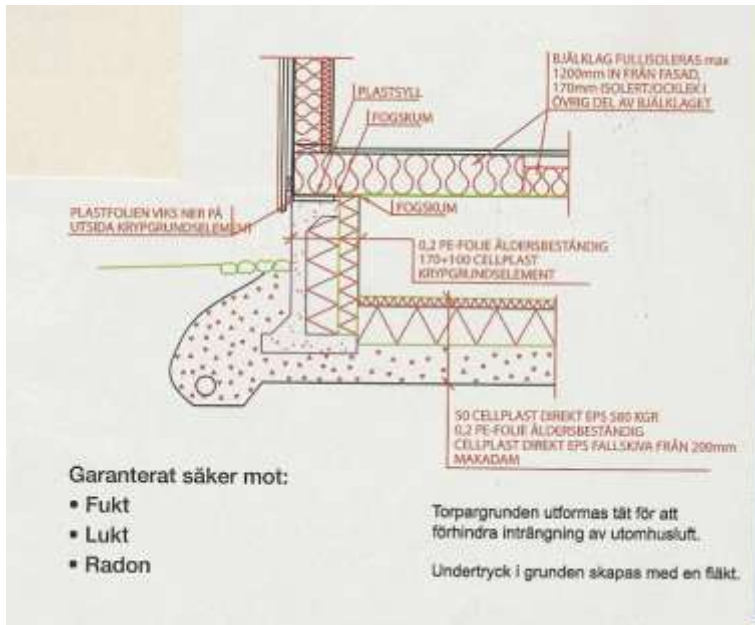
Krypgrund av betongkonstruktion, Tranemogrundern. Källa: Tranemo G-betong.
